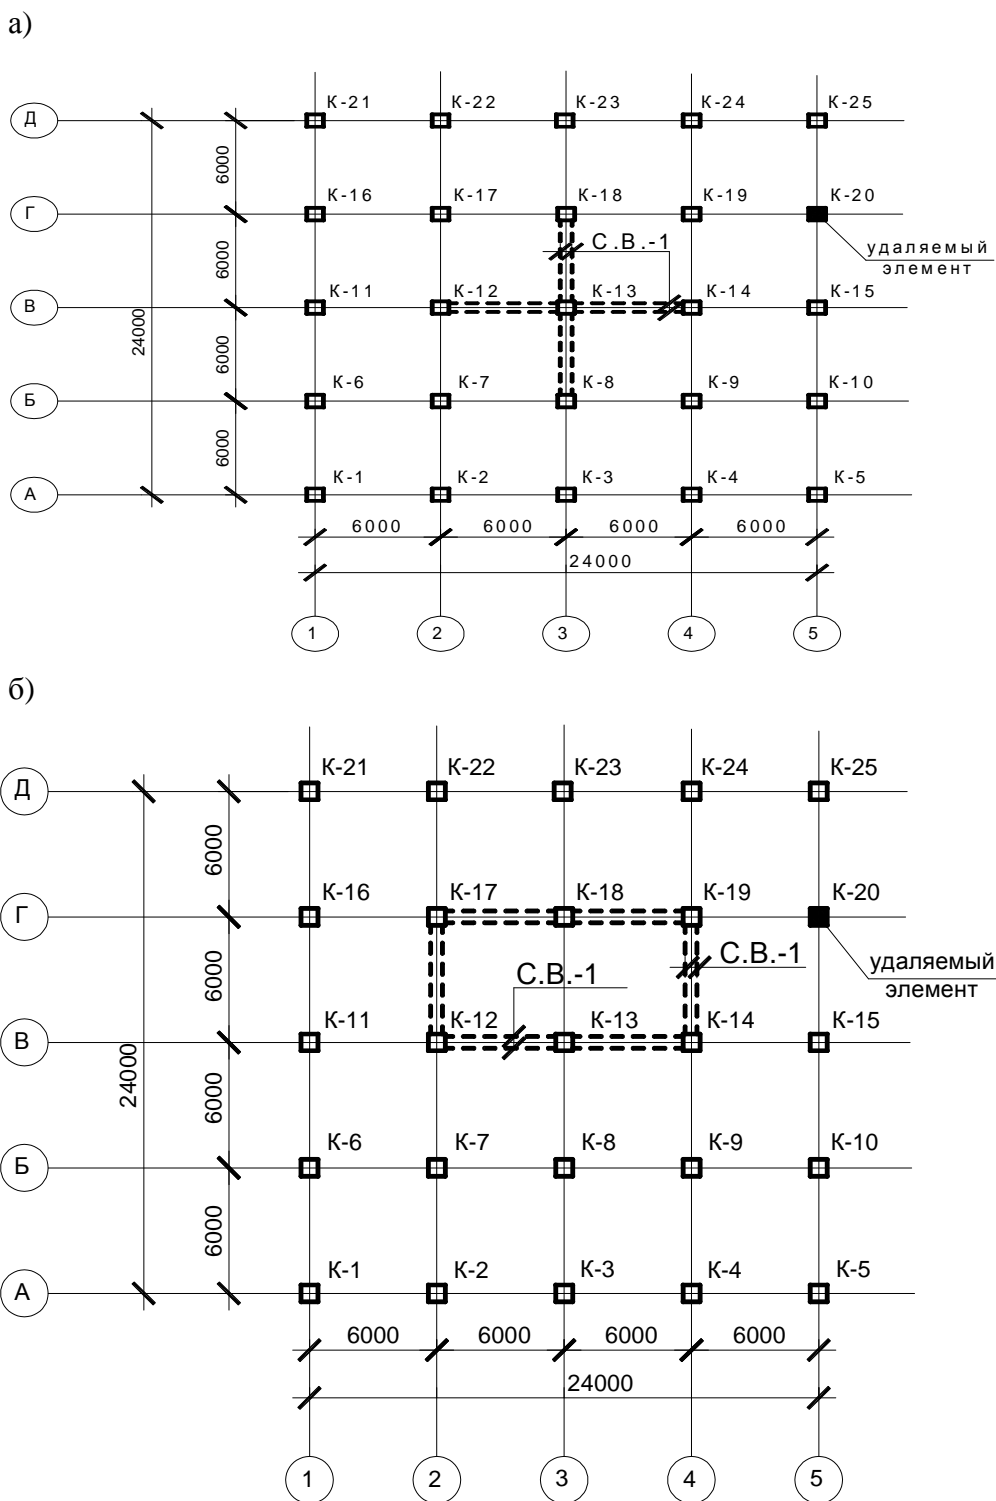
План двенадцатиэтажного безригельного каркасного здания с нумерацией колонн:
